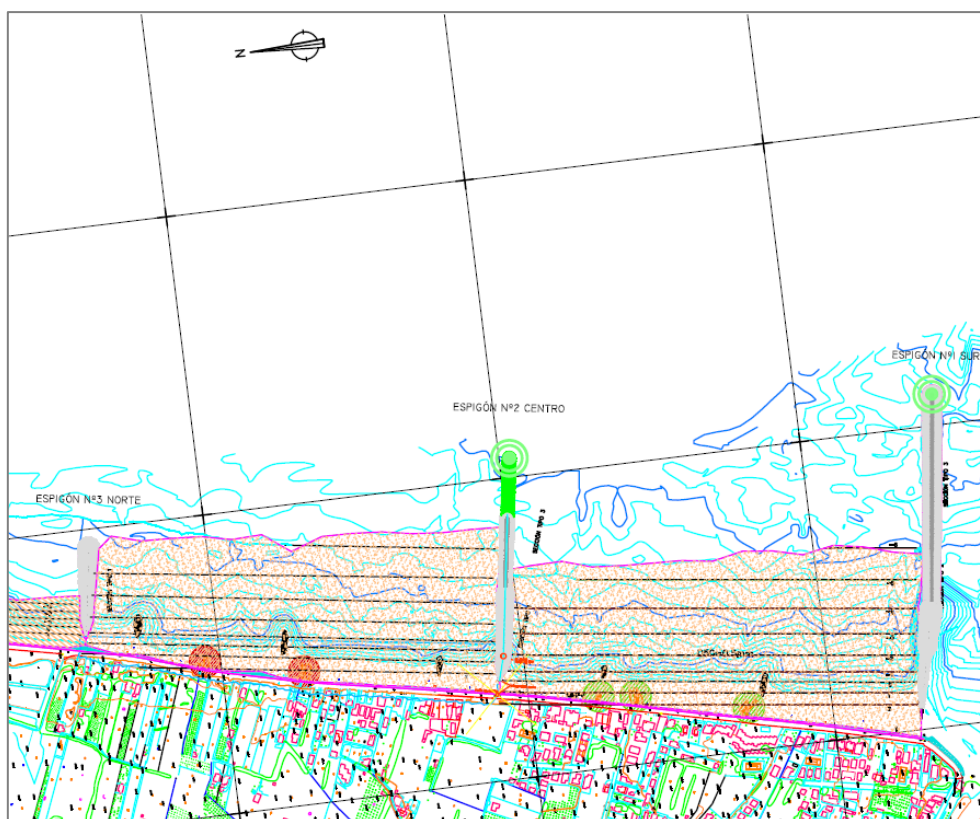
Planta general de las obras del Proyecto de 2006 por el cual la Playa de La Torre adopta su configuración actual.
